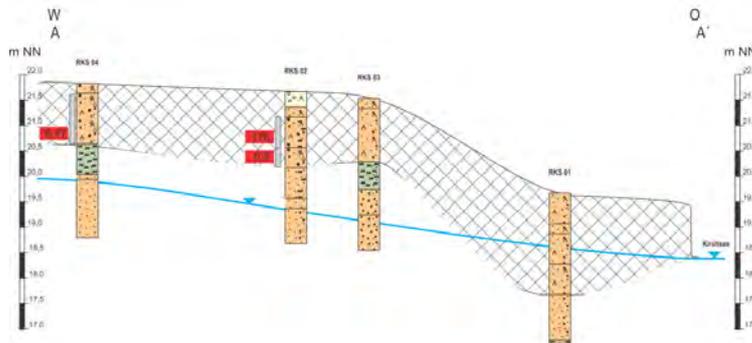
Bodenprofile aus Orientierende Untersuchung, Kirchenstraße 3 – ECOS Umwelt Nord GmbH
